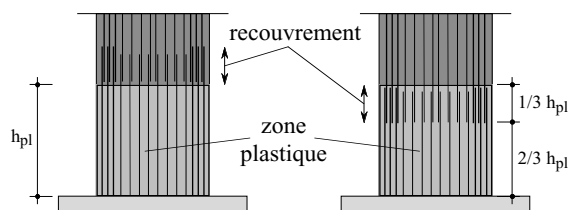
Recouvrement en dehors de la zone plastique (gauche) ou, à défaut, dans le tiers supérieur (droite).
